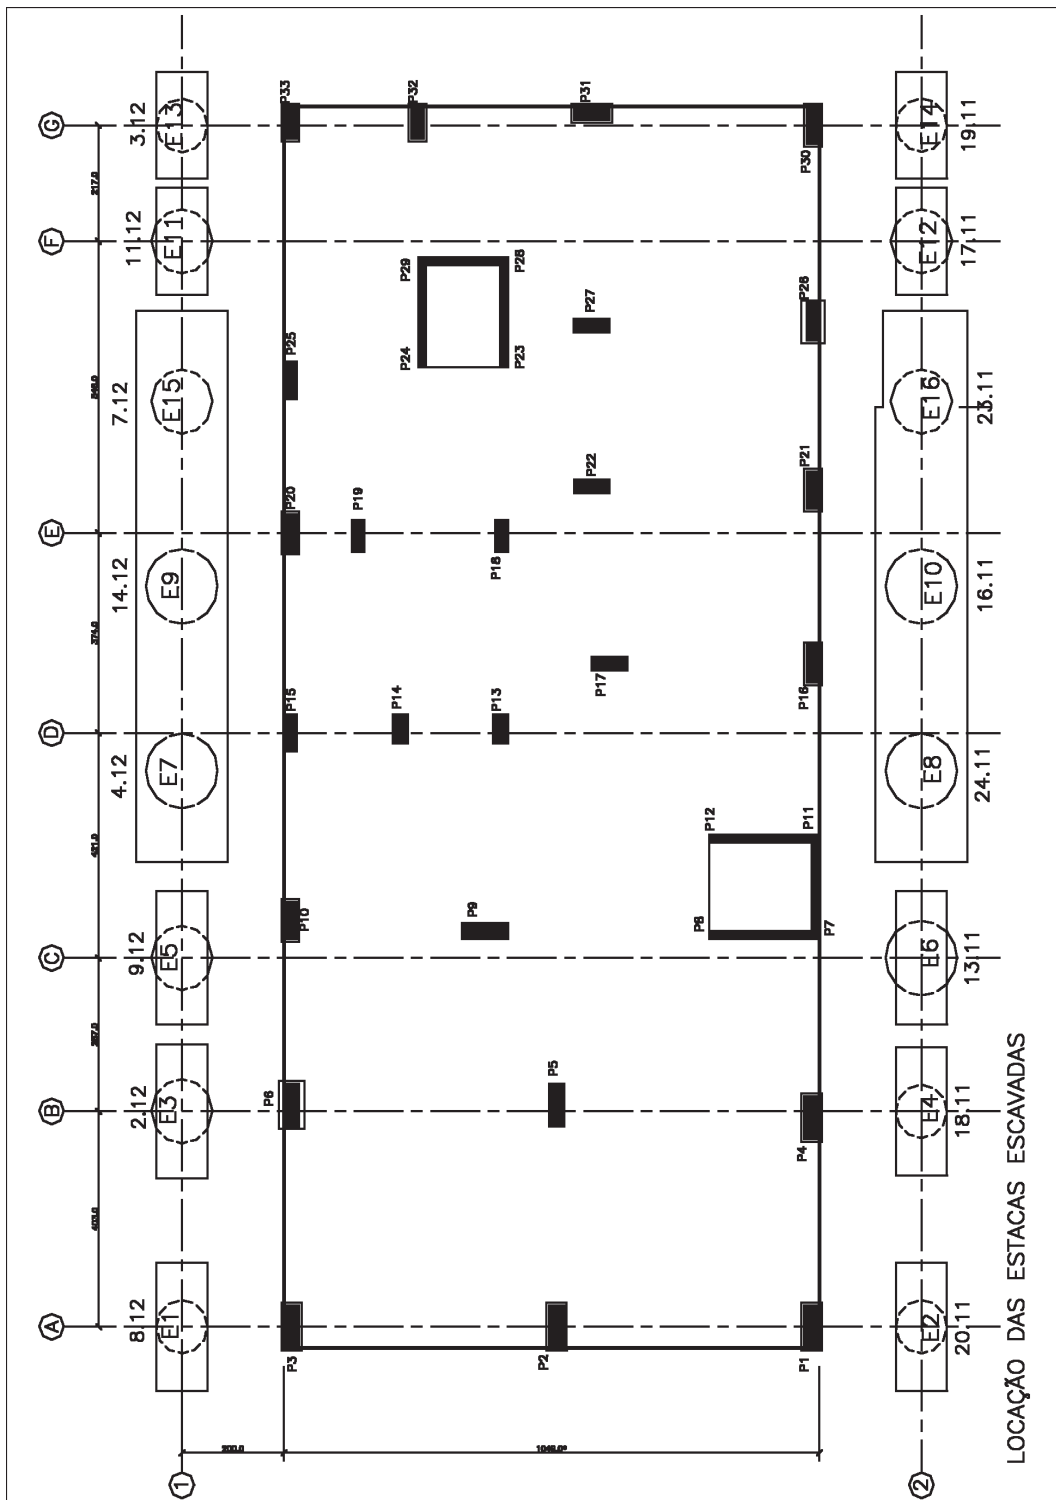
Planta com a localização das estacas, dia e mês de execução, 1998.
